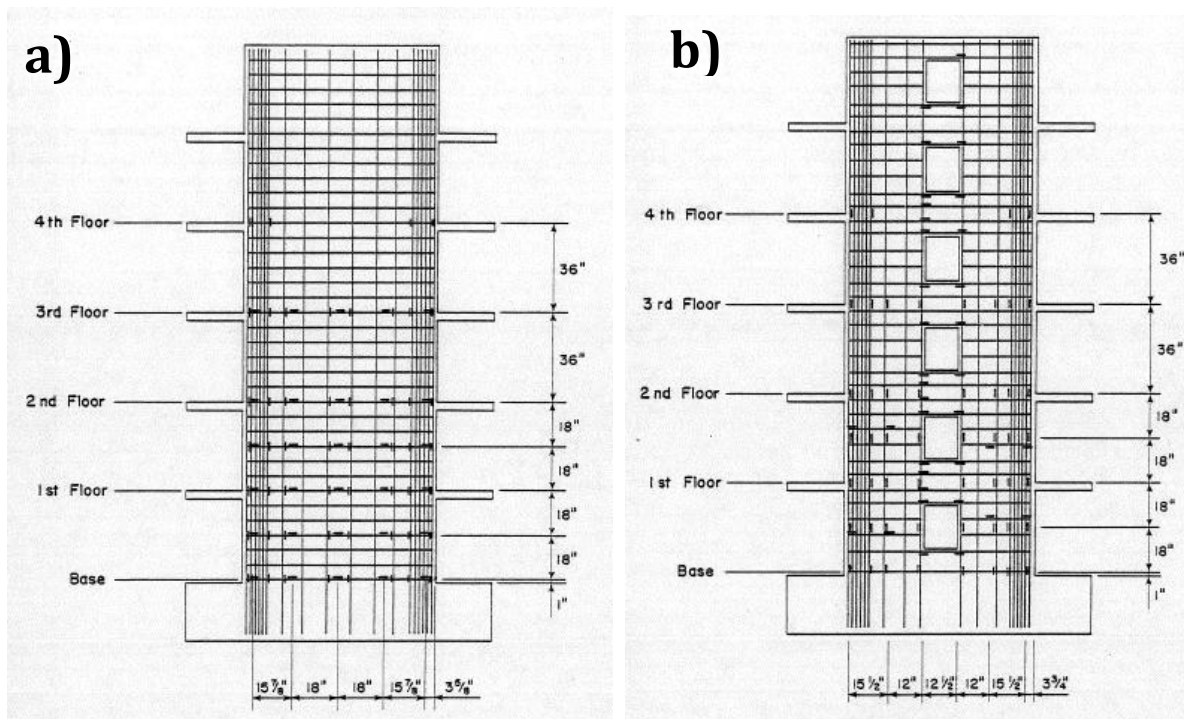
Muro sin aberturas CI-1 (a) y Muro con aberturas PW-1 (b).
